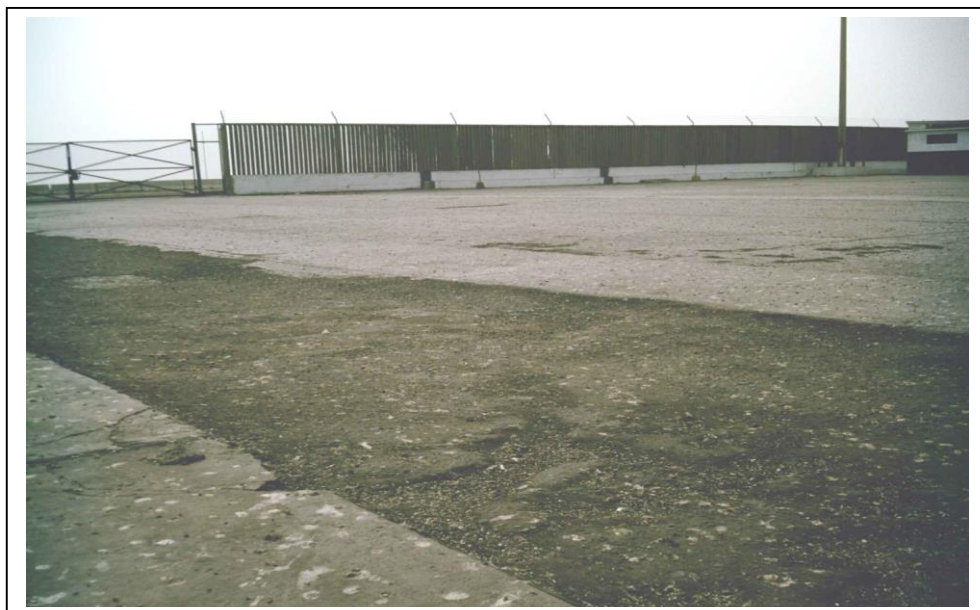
Pavimento flexible; falla total de la estructura ,losa de concreto fallas en esquinas en un nivel de severidad alto.
